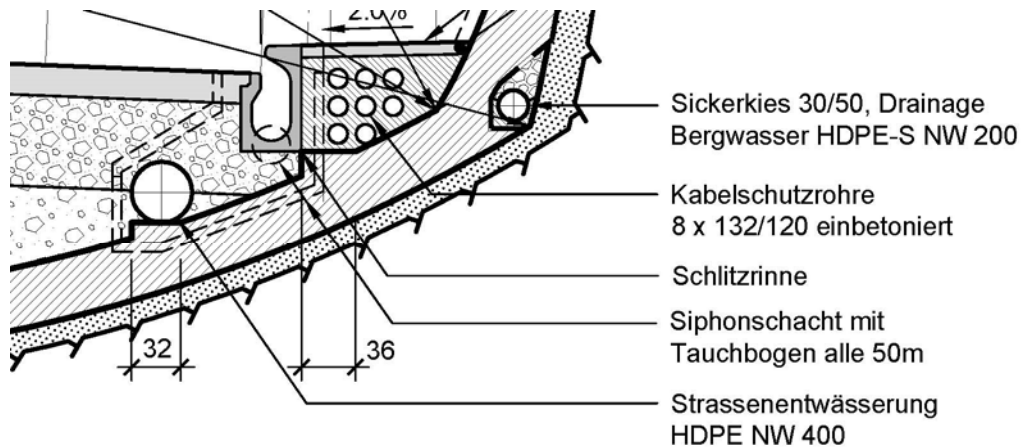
Skizze Hauptsammelleitung (siehe auch Plan TU.101)
